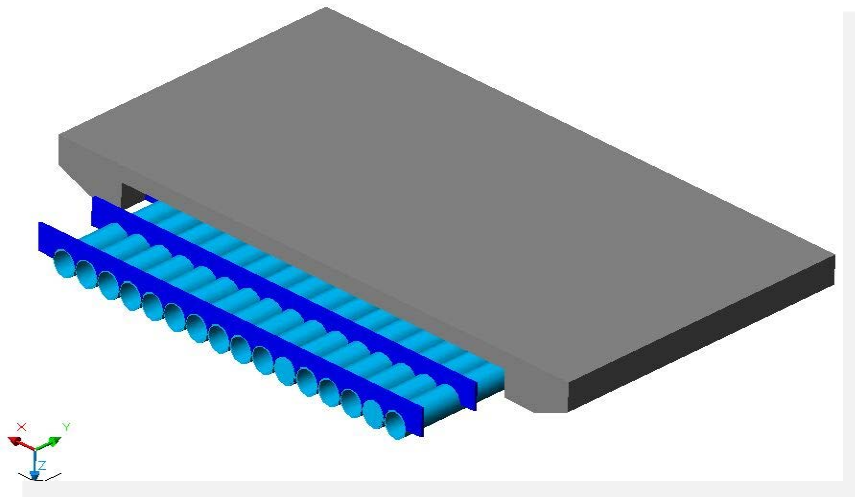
2 – Vedere în spațiu dală cu secțiune mixtă oțel-beton – structura metalică din țevi de oțel
